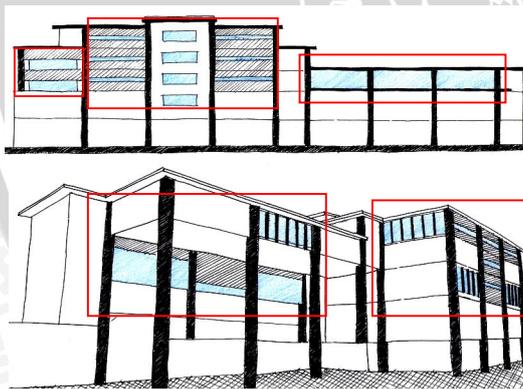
Pengulangan kolom sebagai pembentukan raut pada bangunan baru
